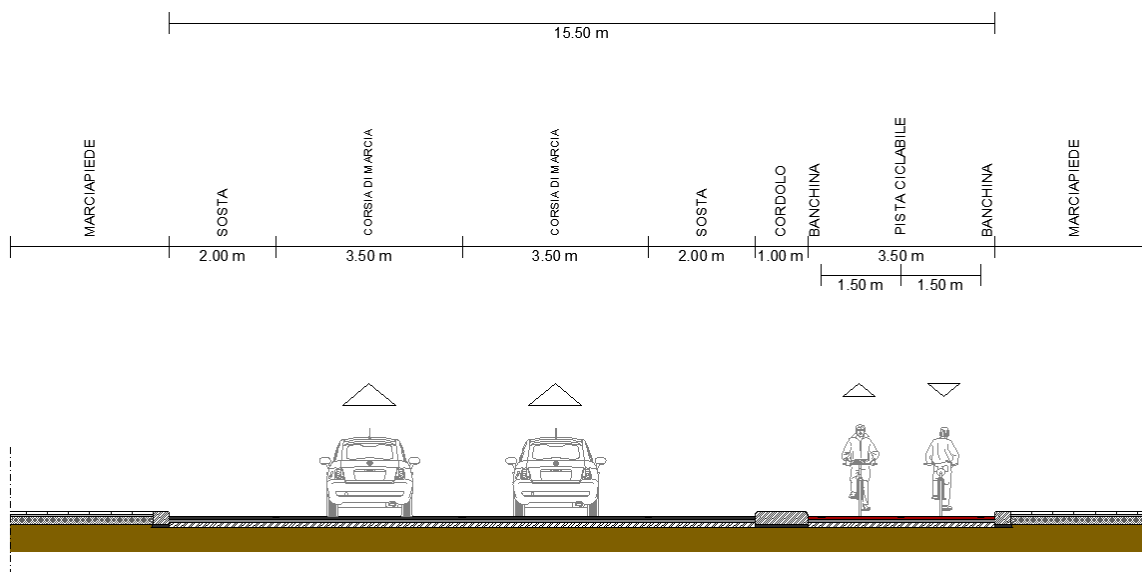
via Giulio Cesare - sezione trasversale di progetto.
